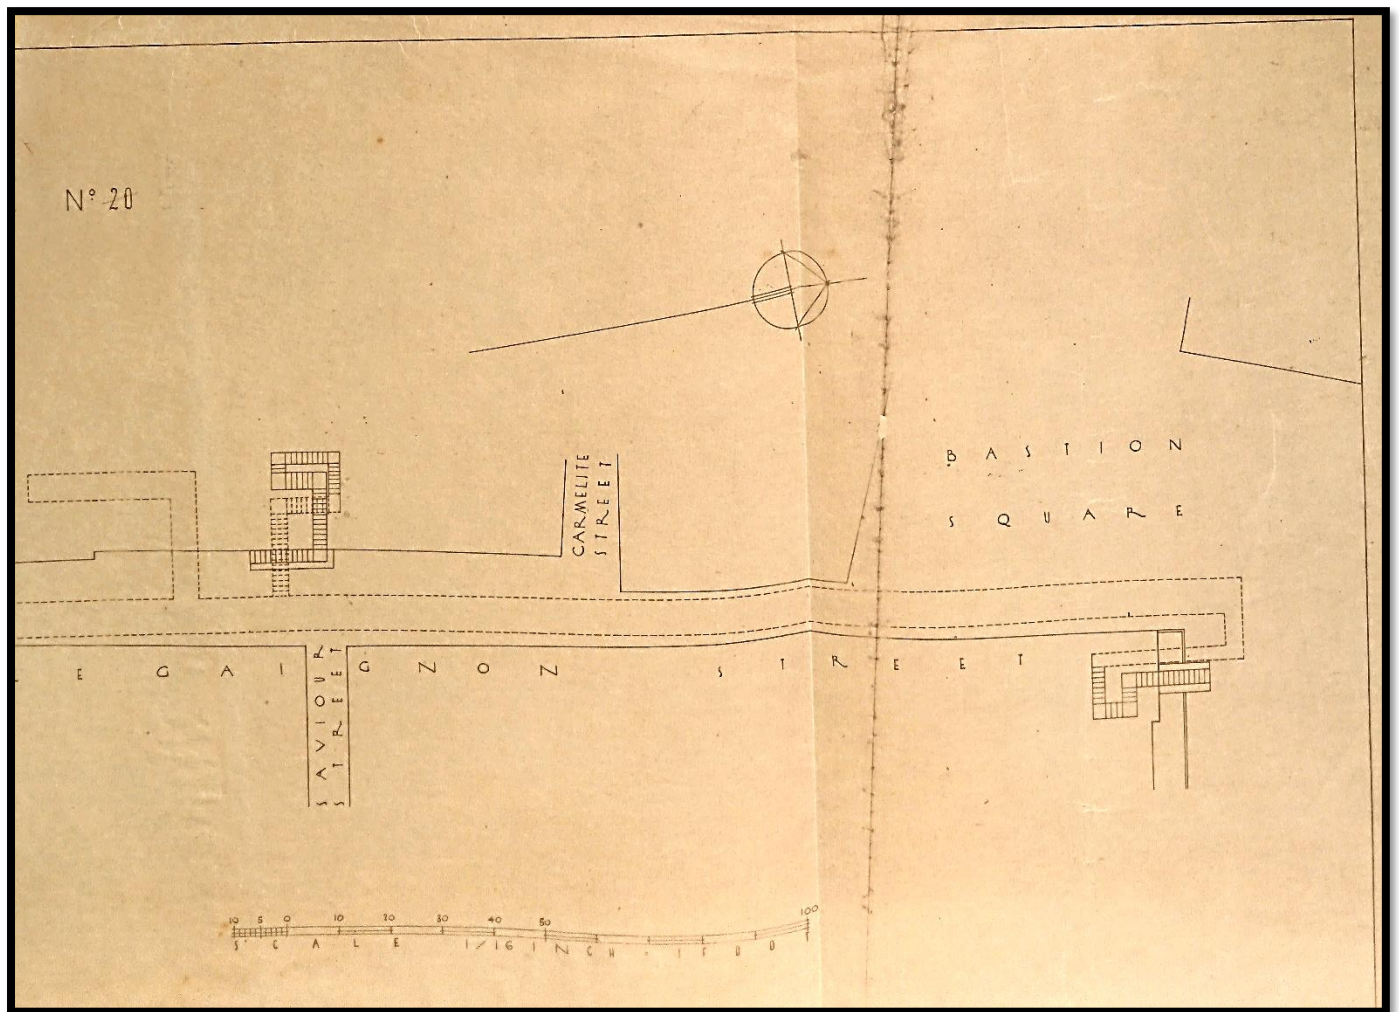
Planta do Abrigo nº20 (5) "Saint Peter Street – Villegaignon Street – Saviour Street – Carmel Street" (Continuação)
